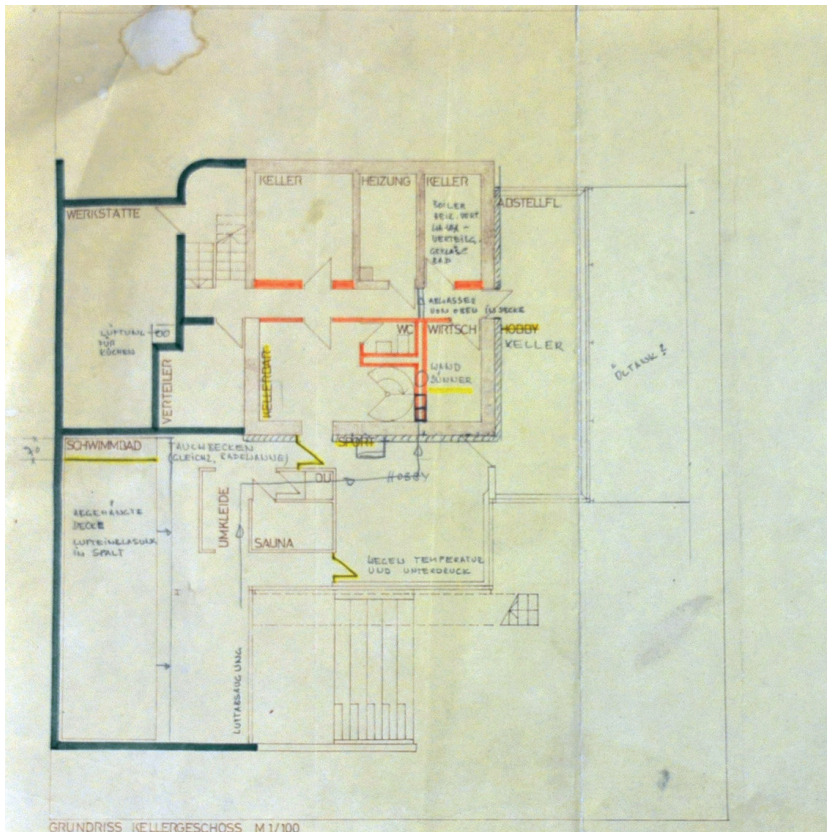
Grundriss Kellergeschoß M:100 mit Bestandsgebäude (grau) und Zubau nach Süden hin (hier skaliert).
